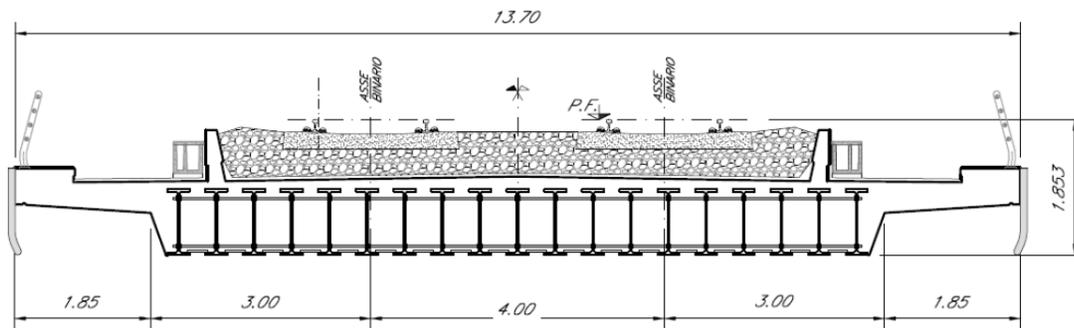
VI02 - SEZIONE TRASVERSALE TIPOLOGICA TRAVI INCORPORATE
